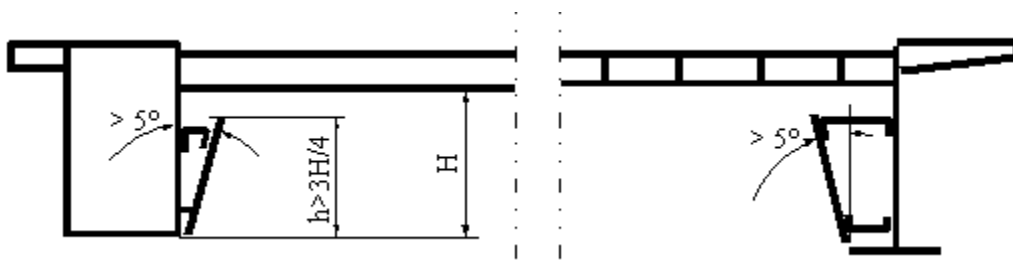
Querschnitt einer Brücke (schematisch) mit Schrägeinbauten
